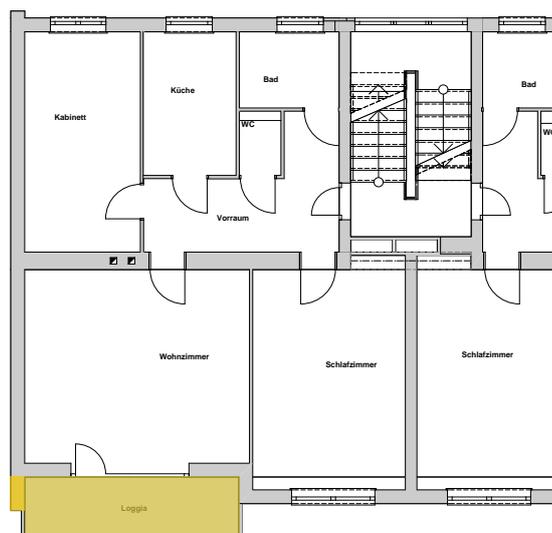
Grundriss mit farbigen Mauerflanken und Loggien [Quelle: eigene Abbildung]
